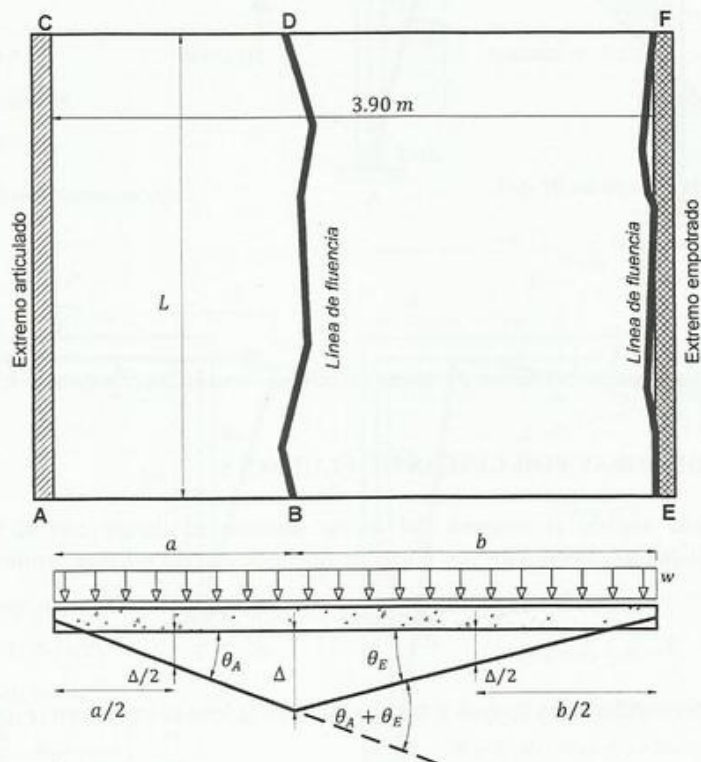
Mecanismo de colapso para la losa -Vista en planta, Ejemplo 16.5-
